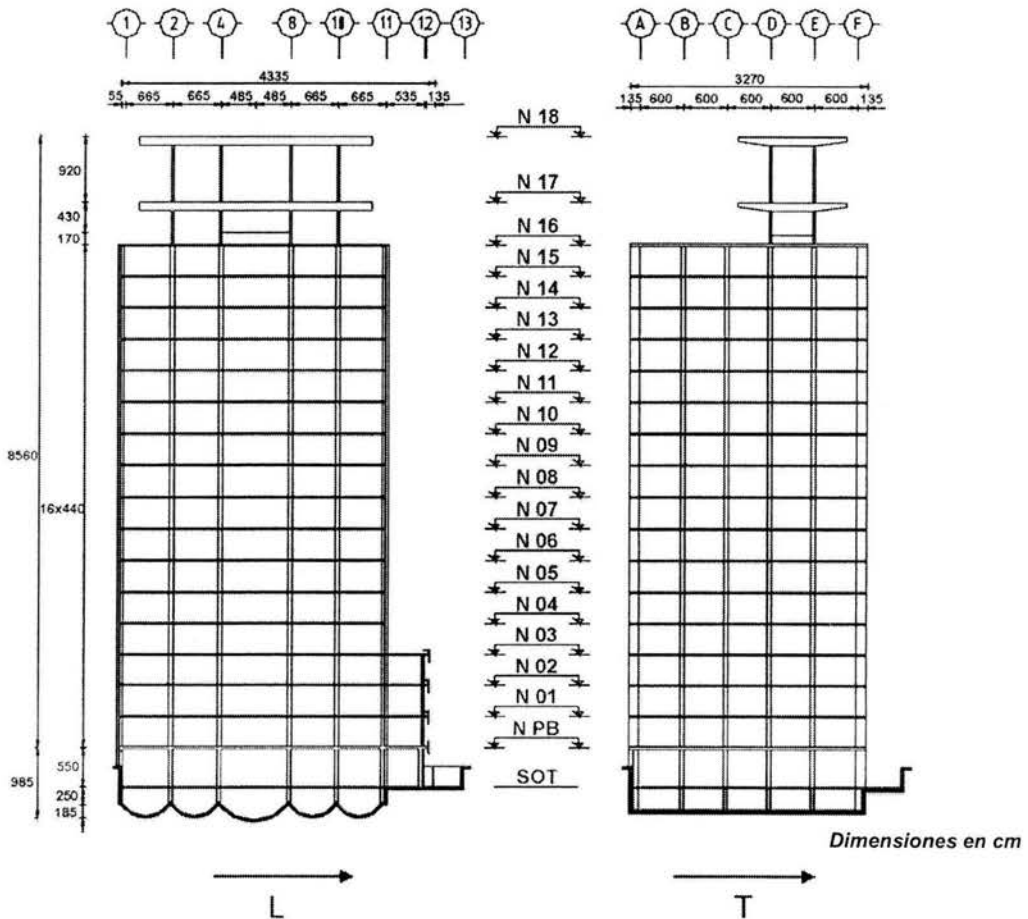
Cortes estructurales del edificio en dirección longitudinal y transversal
